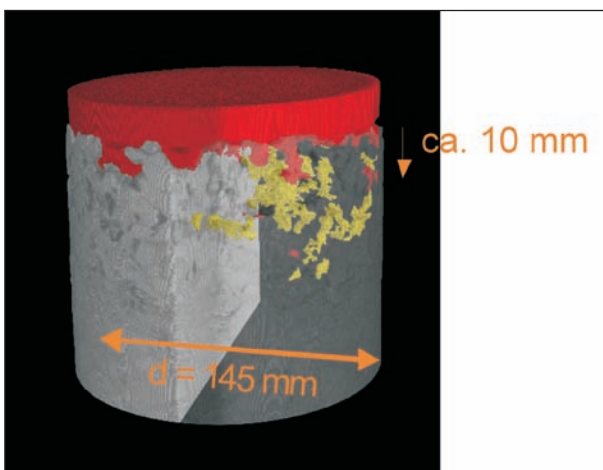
Separierte Hohlraumstruktur eines OPA-Ausbaukörper nach mehr als 10-jähriger Nutzung
